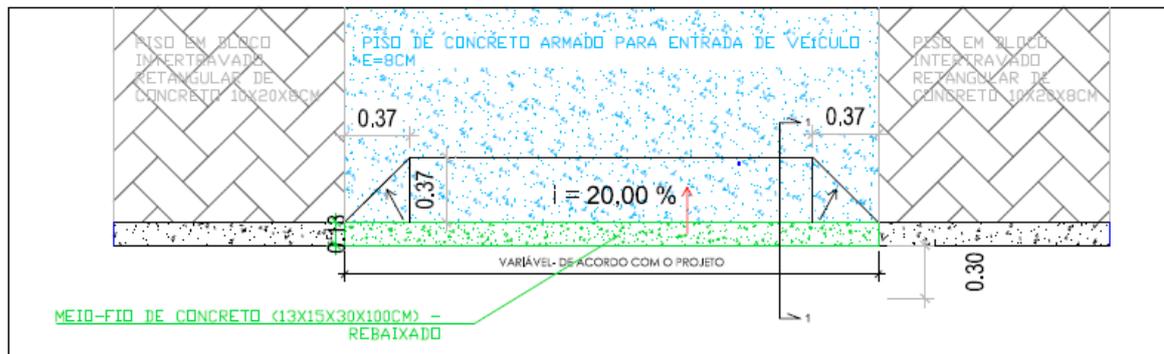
Detalhe construtivo em planta baixa esquemática das rampas de garagem de veículos leves e pesados a executar na Rua Tegino Vargas
